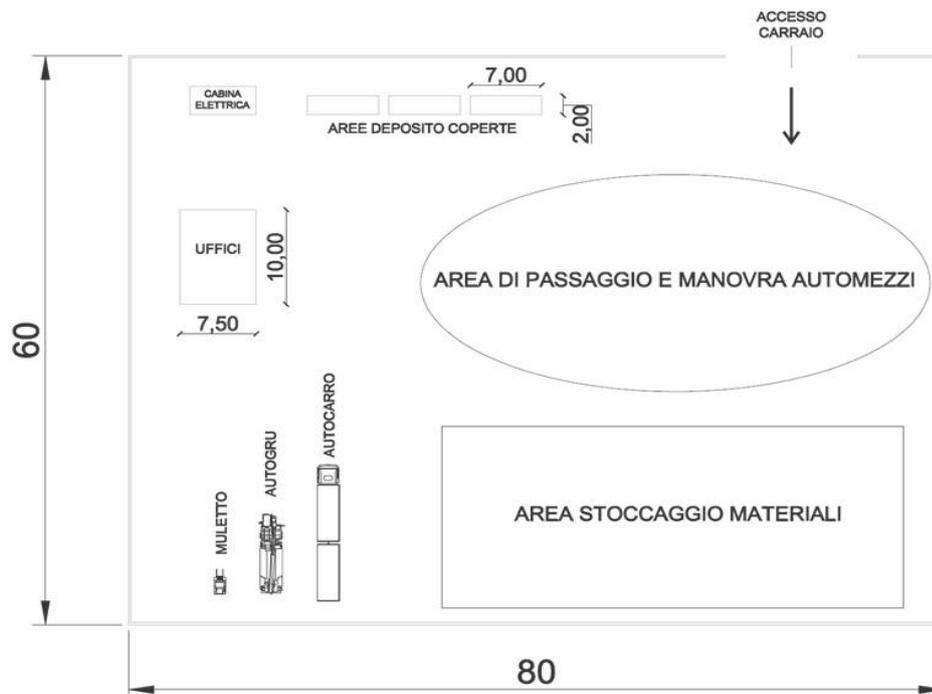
Planimetria dell'area centrale di cantiere - misure indicative
